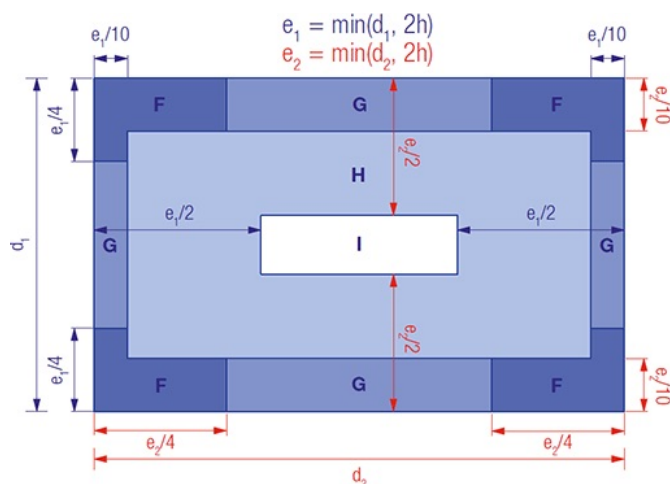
Dimensions des zones d'angle, des zones de rive et des zones centrales sur une toiture plate (indépendamment de la direction du vent) (h = hauteur de la toiture)
